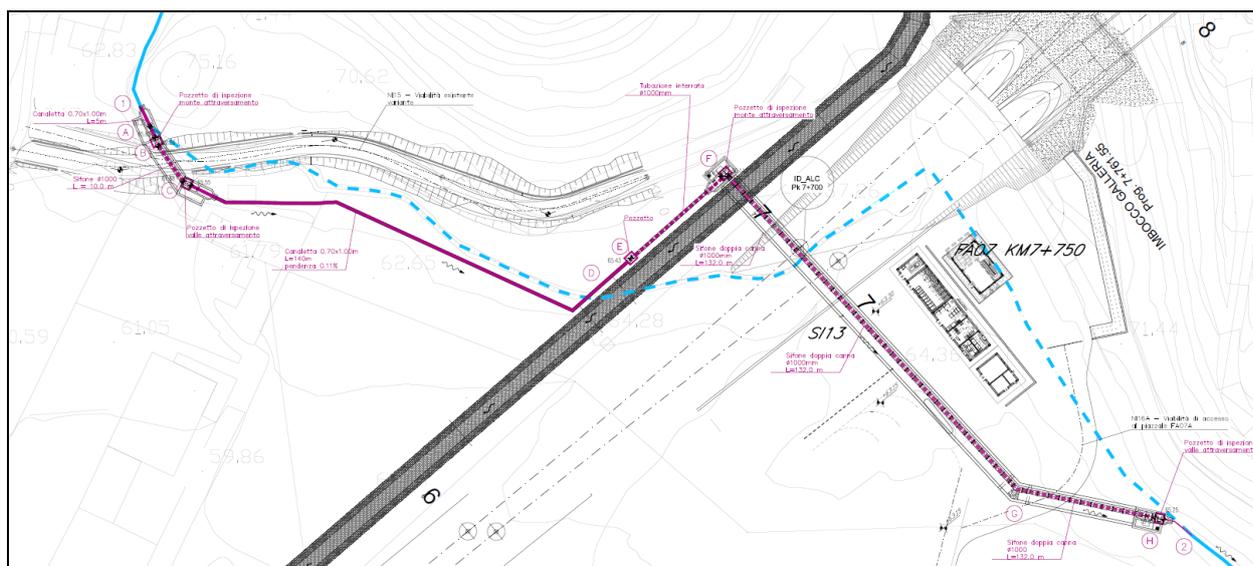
Planimetria della risoluzione dell'interferenza con il canale Alcantara.
